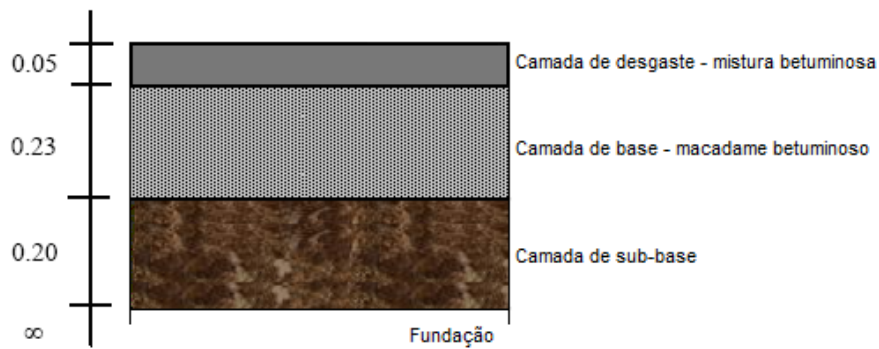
Estrutura do pavimento degradado – Caso 1 (Adaptado de Picado-Santos & Pereira, 2006)
